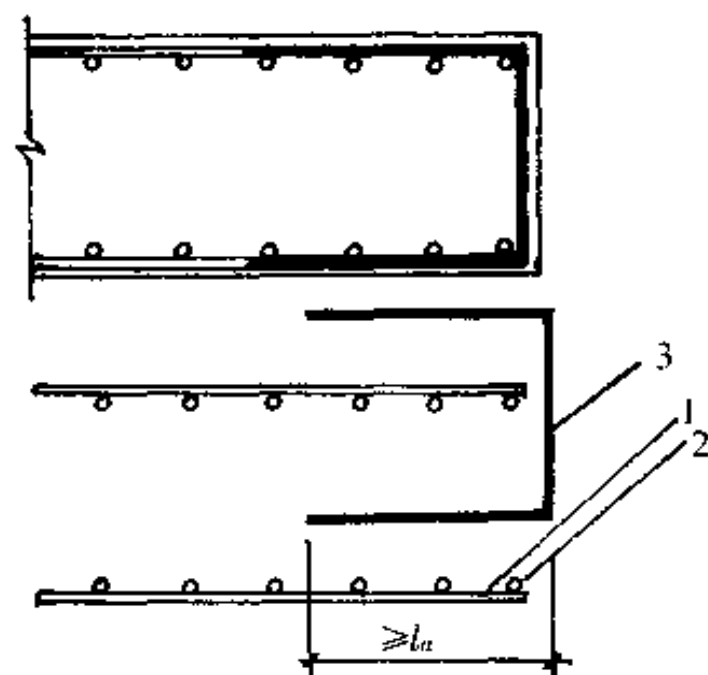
钢筋焊接网在墙体端部(无暗柱)的构造图
